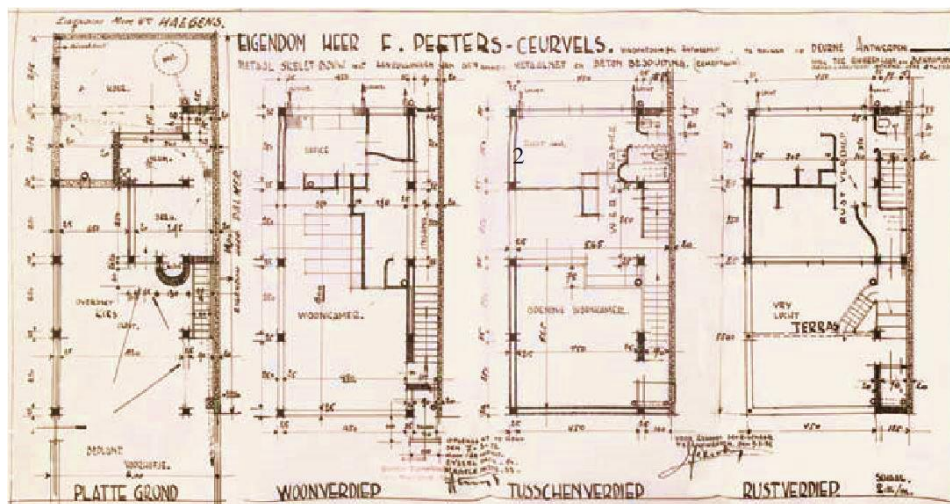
Planos de planta Casa Peeters. Abril 1932.
